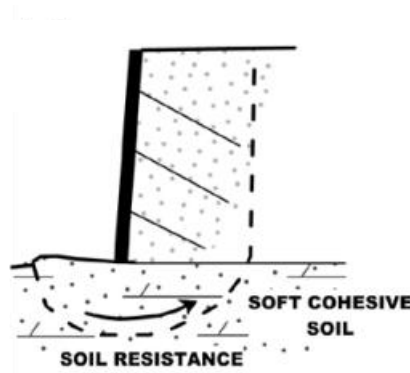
Fallo por falta de capacidad portante del soporte produciendo levantamiento de fondo o basal heave (Fuente: Soil Nail Walls – Reference Manual (FHWA, 2015))
